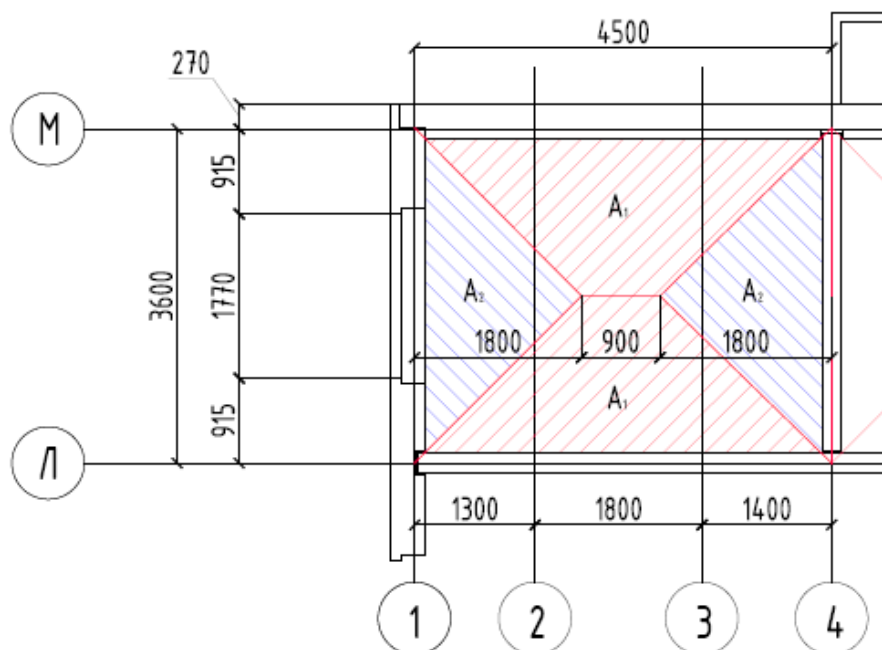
схема передачи нагрузки с плиты перекрытия на стеновые панели.
